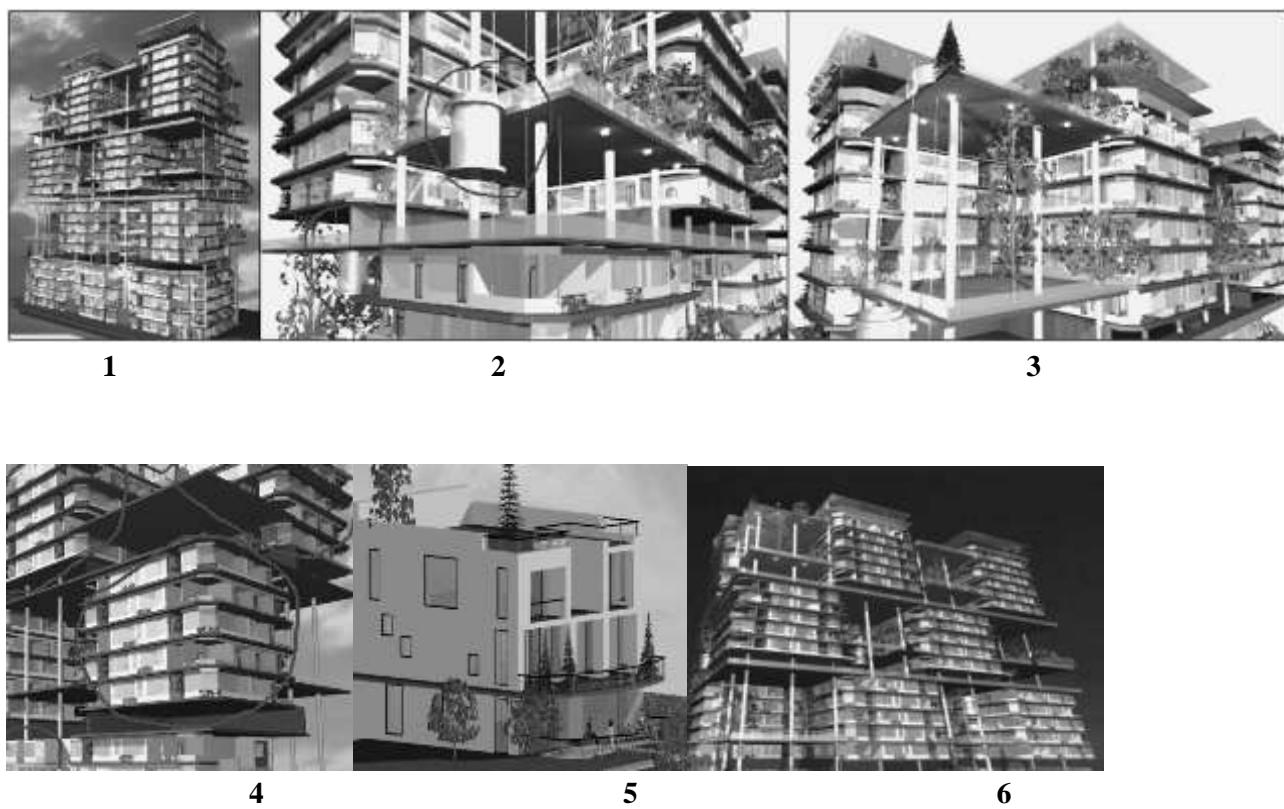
Проектна пропозиція реконструкції 5-поверхової будівлі
